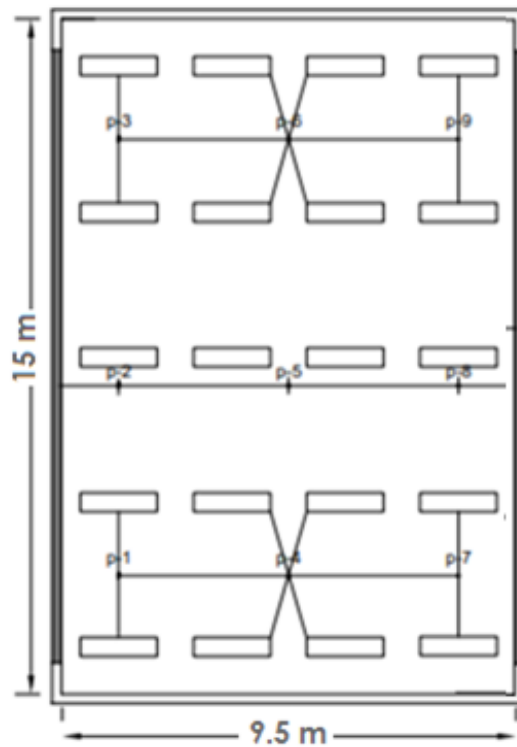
Planilla 2, para los espacios hacia el interior del estacionamiento (Elaboración propia con base en NOM-025-STPS-2008).
